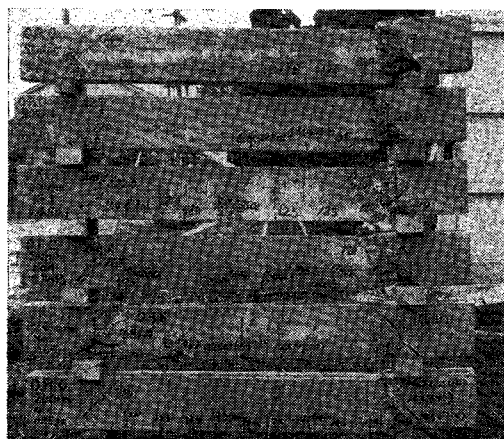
(イ) 過鉄筋コンクリートばりの右側の破壊様相
